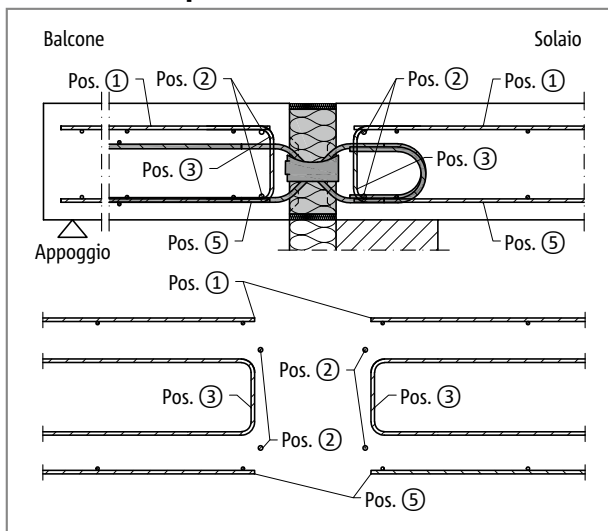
Schöck Isokorb® T tipo QP-VV: armatura in opera
